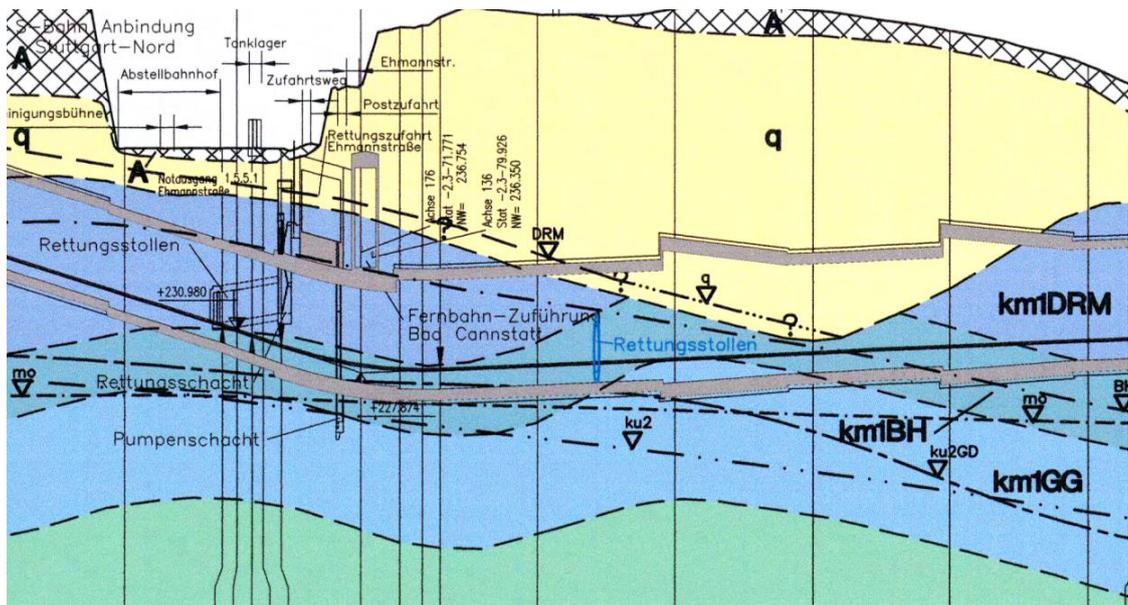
Geologischer Längsschnitt Rosensteintunnel S-Bahn im Bereich des Rettungsschachtes (PfA 1.5, Anlage 19.2.5). In Grau die Bauwerke des Rosensteintunnels S-Bahn, strichpunktiert der Mineralwasserdruckspiegel „mo“. Links Richtung Mitnachtstraße, rechts Richtung Bad Cannstatt.
